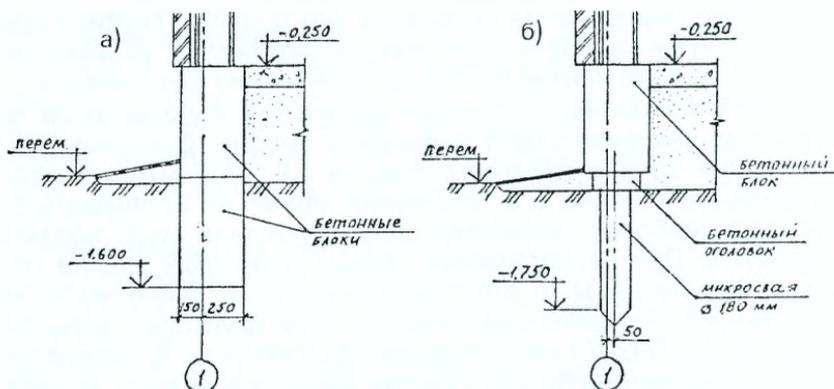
Фрагмент фундаментов усадебных домов.
